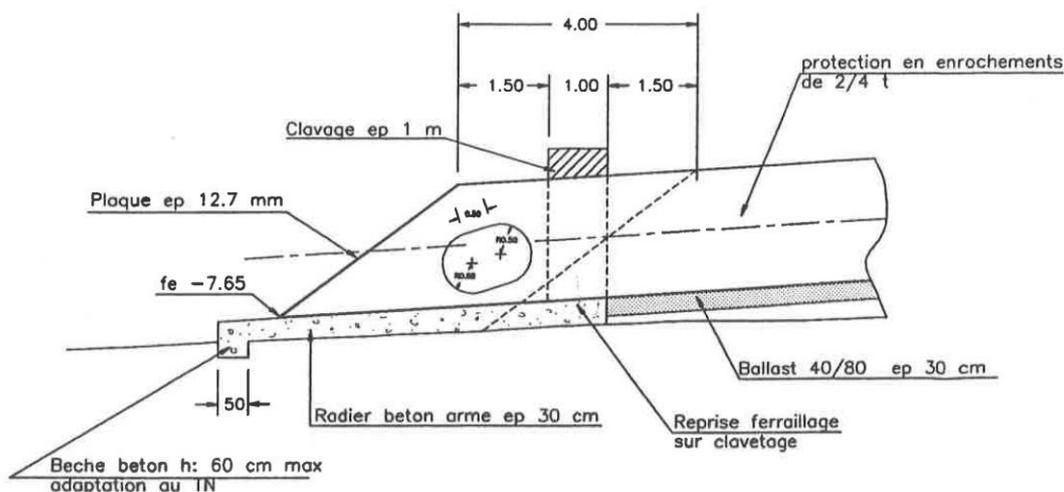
Coupe longitudinale du diffuseur (Source SPADA 1193)
